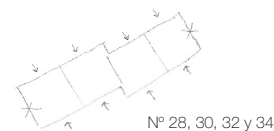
Bocetos en planta de la disposición de las construcciones situadas en la Rúa Bueu-Coia, nº 28, 30, 32 y 34 (autoría propia).
